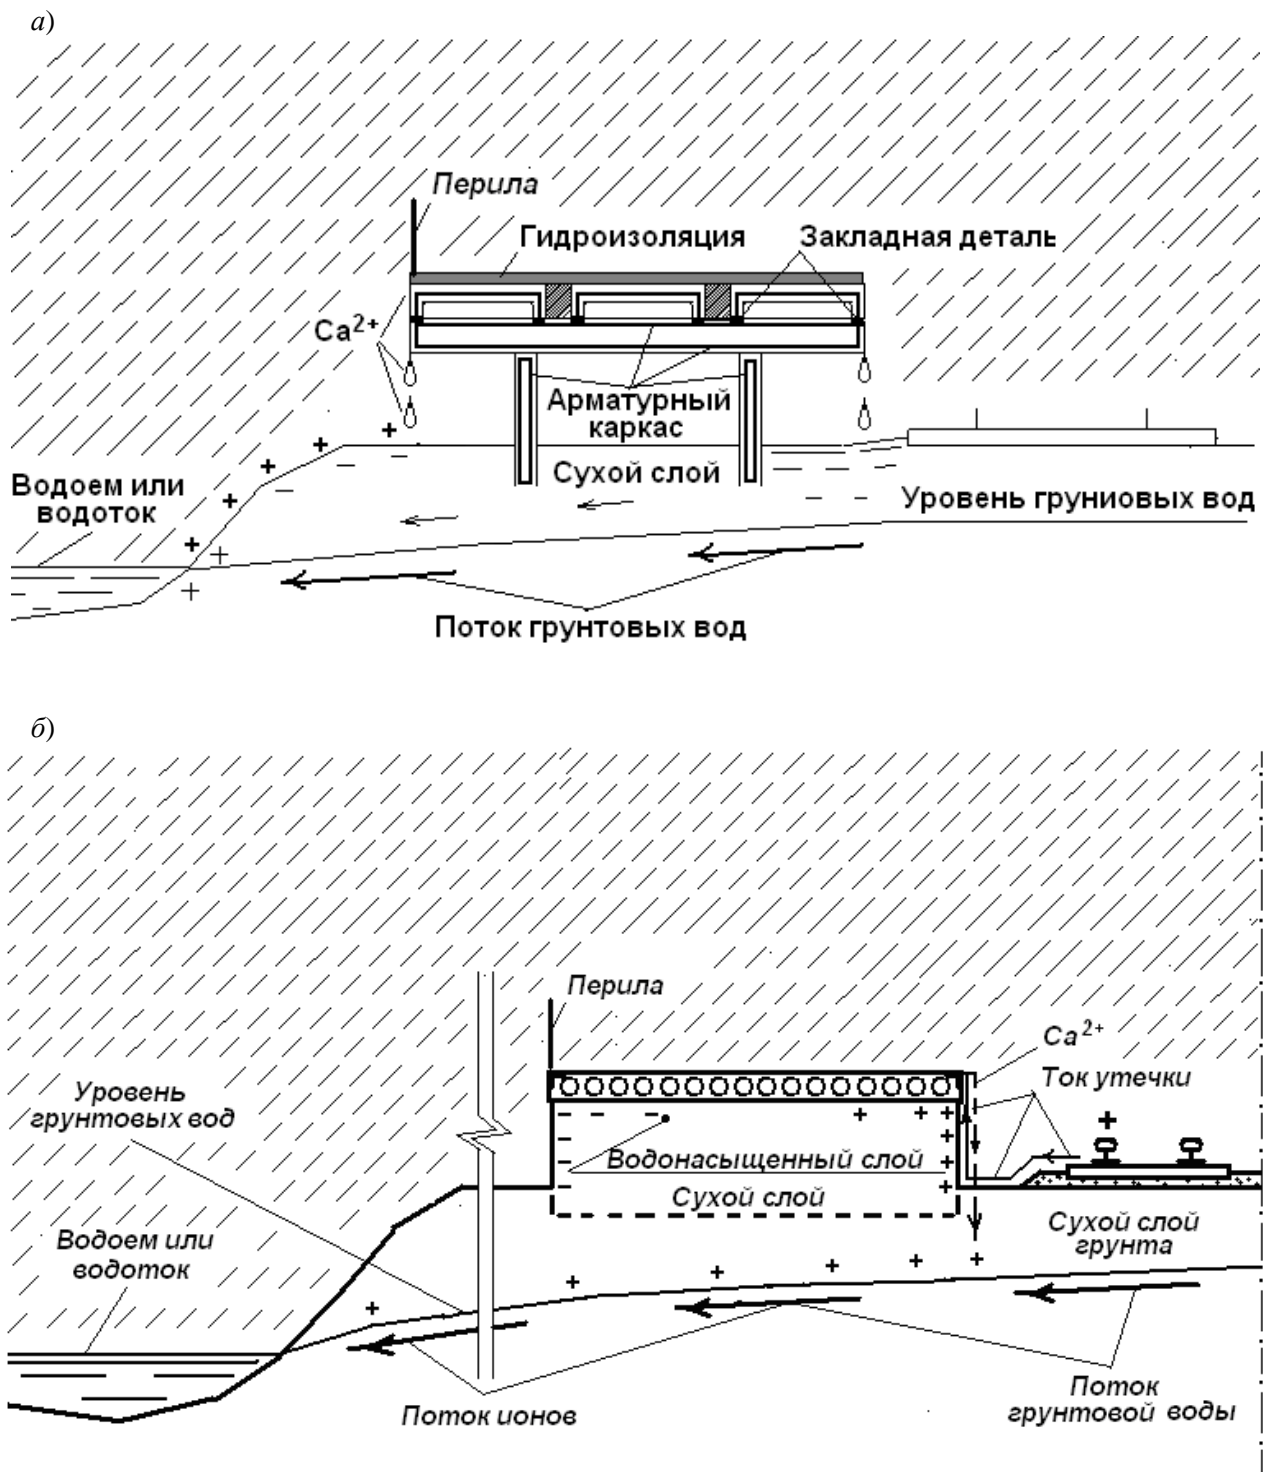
Схема протекания тока утечки с рельсов в конструкции высокой пассажирской платформы с бетонными опорами (а) и с железобетонными стойками и ригелями (б)
